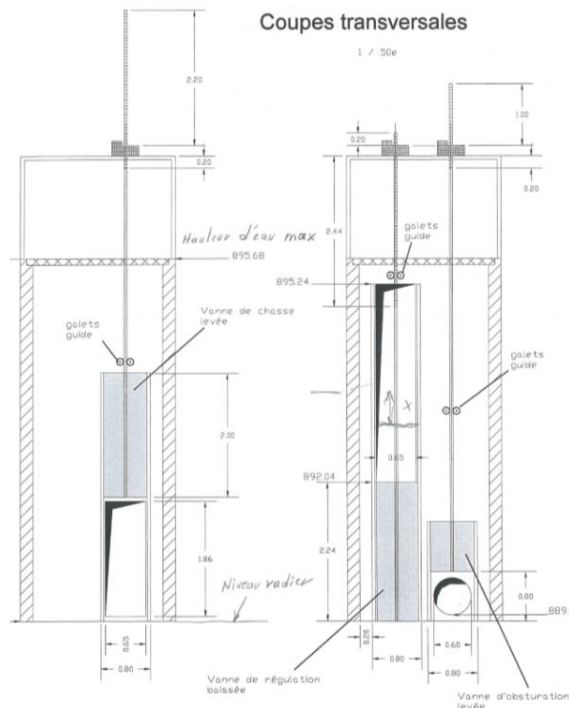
Plan du puits de dévalaison ci-contre (étude SIEE 2003)
